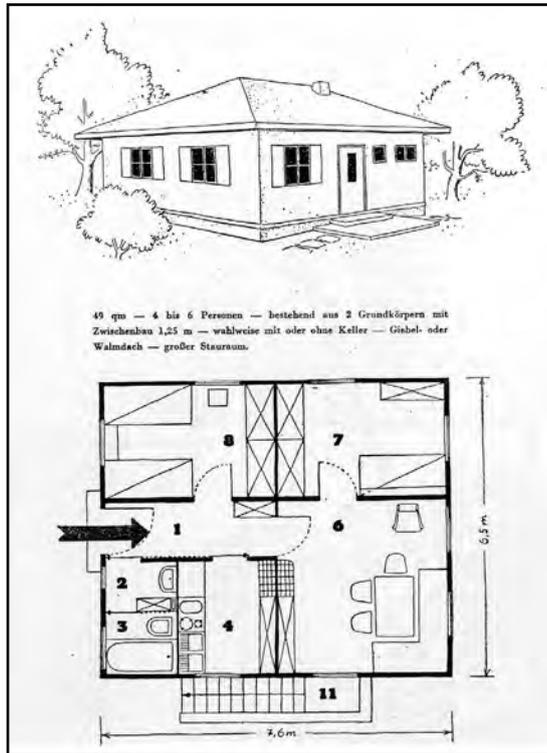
| Platex-Hausbau GmbH Haus 10, Typ B 49, Ausstellung „Das Fertighaus“, 1947
